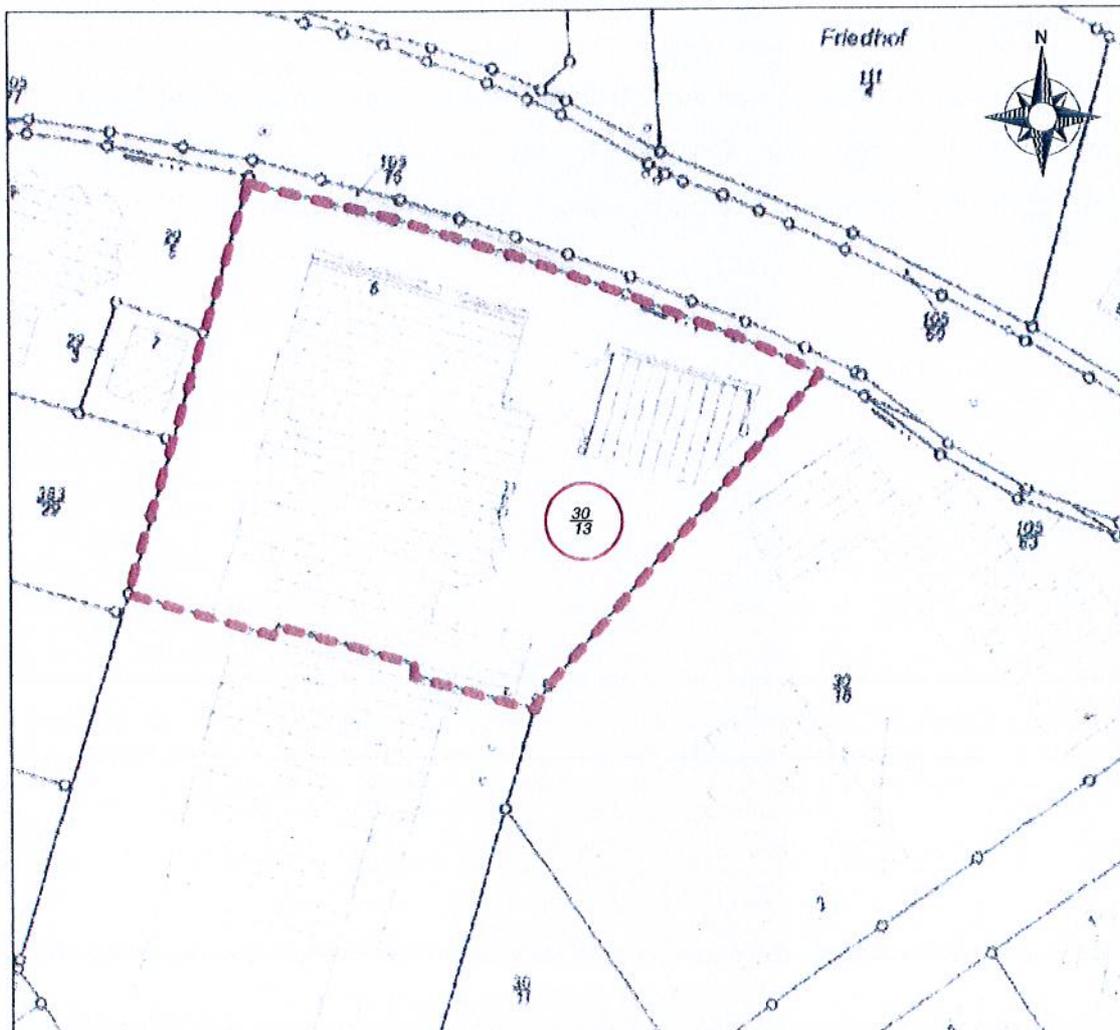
Lageplan - aktuelle Betriebsfläche
